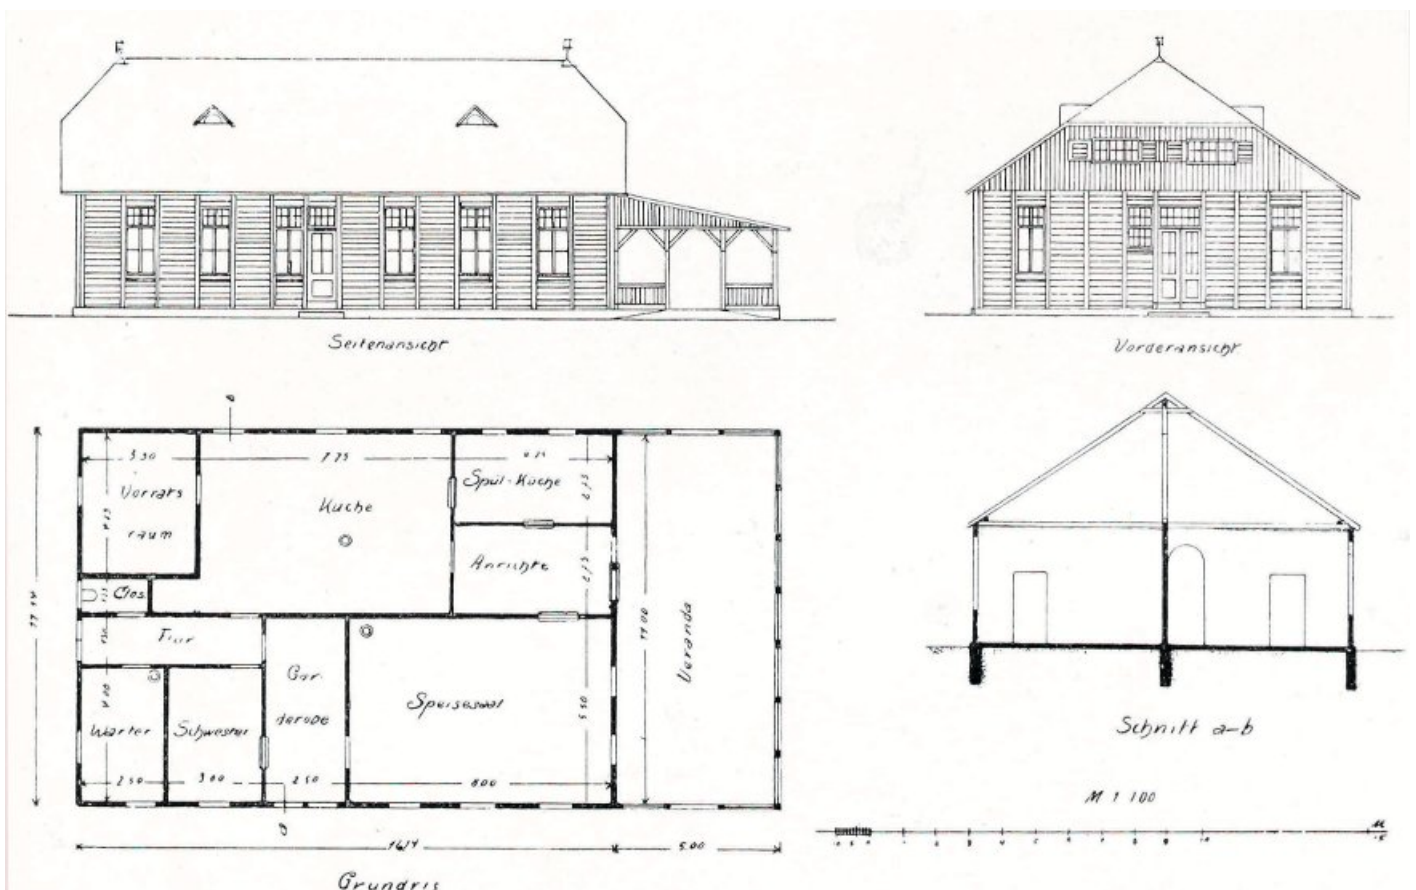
Ansicht und Grundriss des Wirtschaftsgebäudes.
